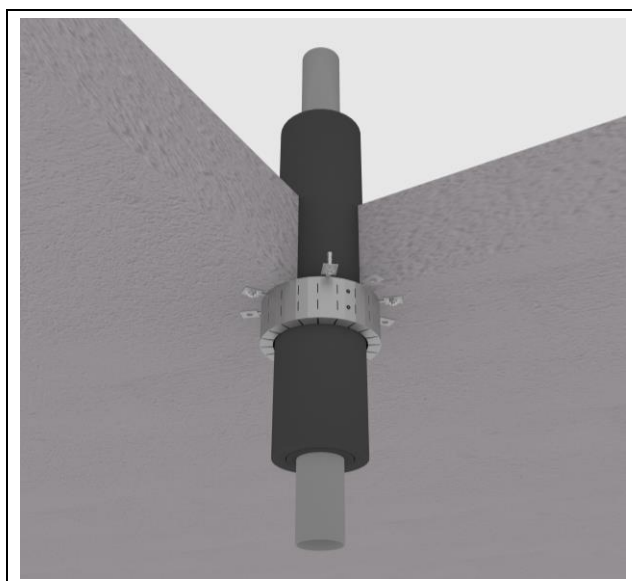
Ejemplo de sellado de penetración de tubería metálica aislada en un suelo.
